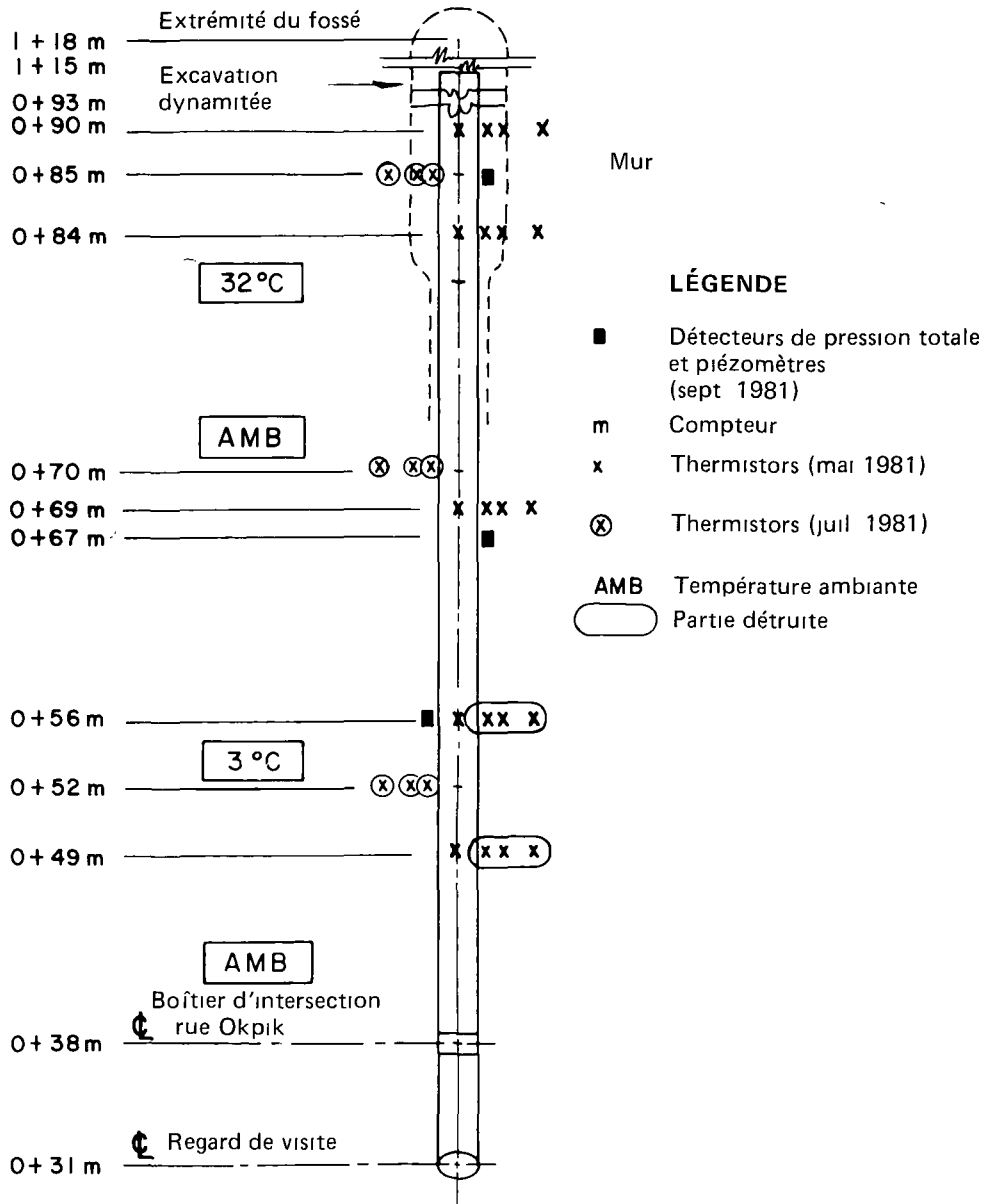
PLAN DE LA SECTION EXPÉRIMENTALE
